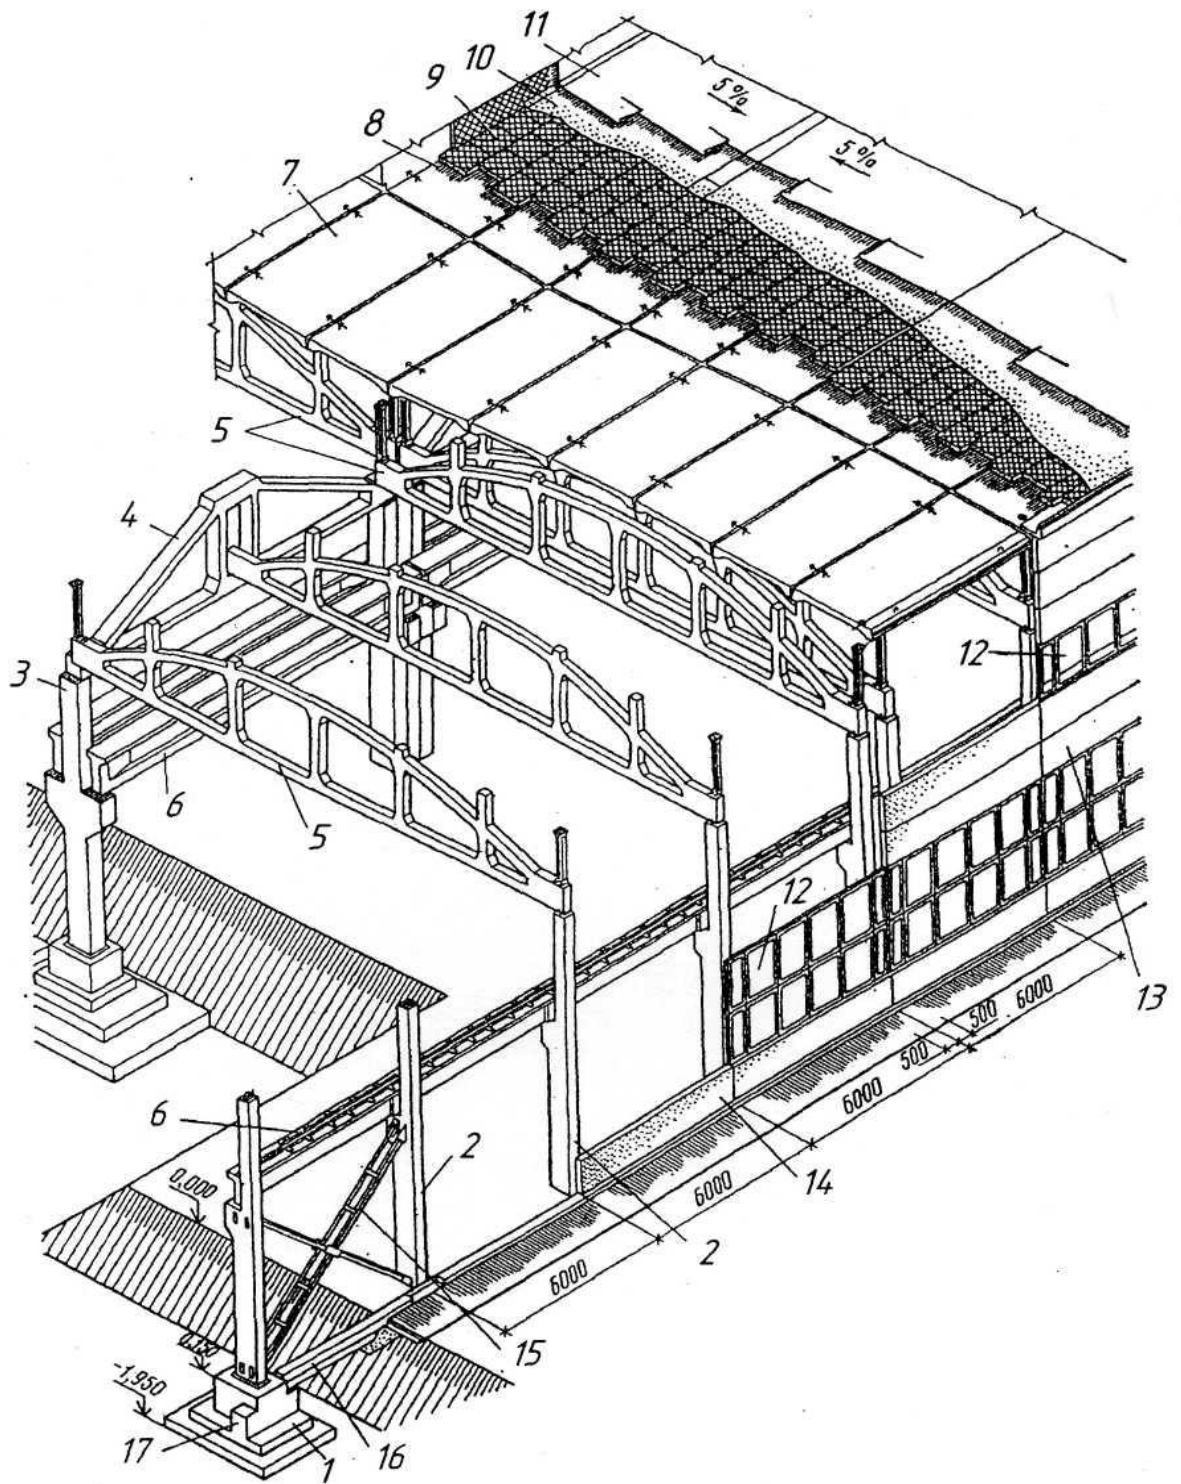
Конструктивное решение одноэтажного многопролетного промышленного здания: 1 - монолитный железобетонный фундамент под колонну; 2 - колонна крайнего ряда; 3 - колонна среднего ряда; 4 - подстропильная железобетонная ферма; 5 - железобетонная безраскосная ферма (стропильная конструкция); 6 - подкрановая балка; 7 - железобетонная ребристая плита покрытия; 8 - пароизоляция; 9 - слой утеплителя; 10 - цементная стяжка; 11 - водоизоляционный материал (наплавляемая кровля); 12 - остекление; 13 - стенная панель; 14 - цокольная стенная панель; 15 - металлическая крестовая вертикальная связь между колоннами; 16 - железобетонная фундаментная балка; 17 - бетонный подлив для опирания фундаментных балок
